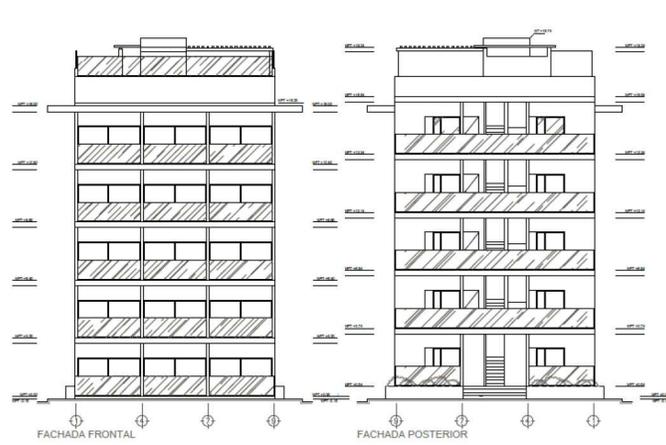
Vista frontal y posterior de la fachada de las torres
